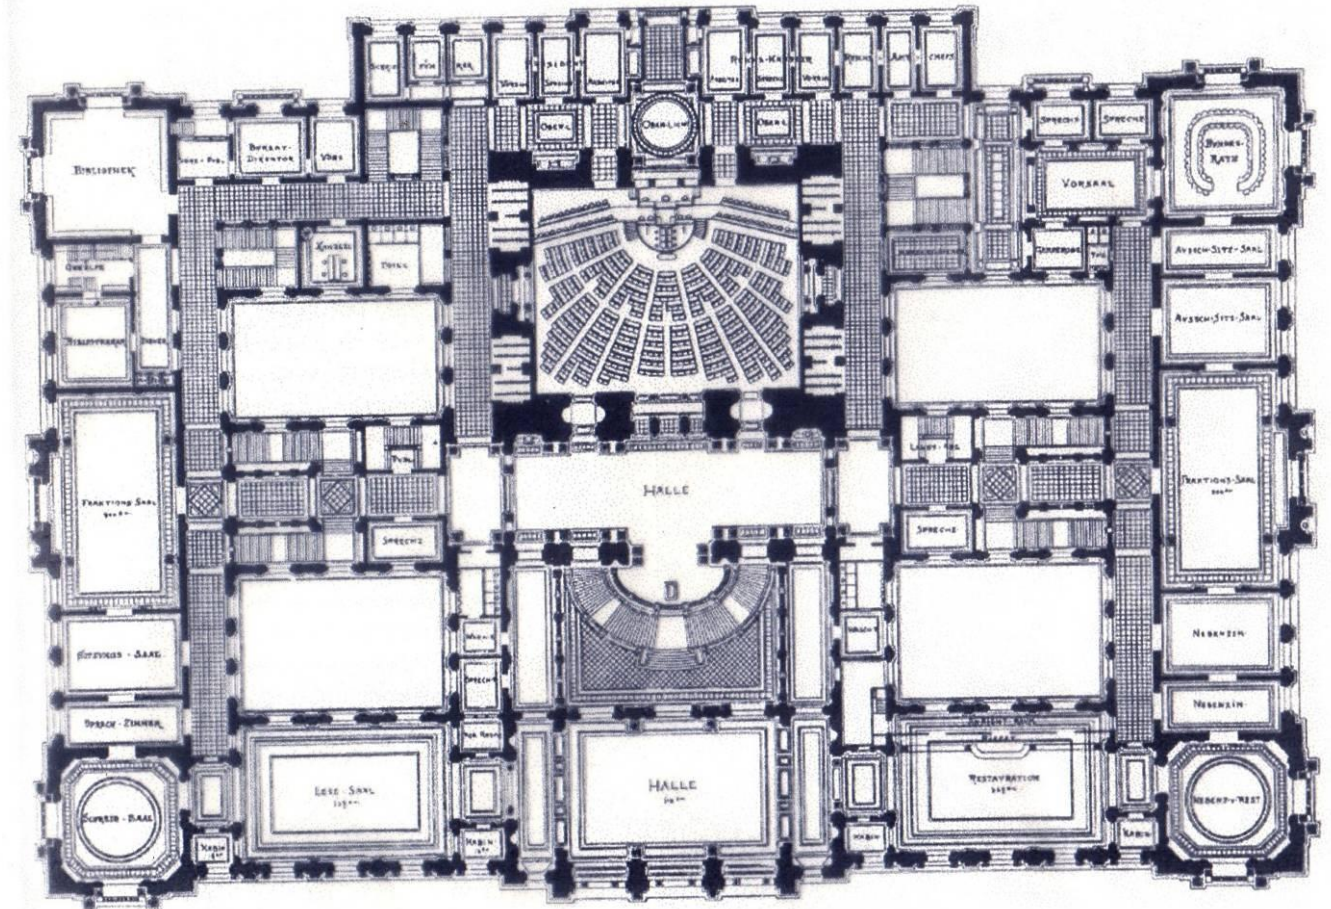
Plan du Reichstag (Cullen, 2)
